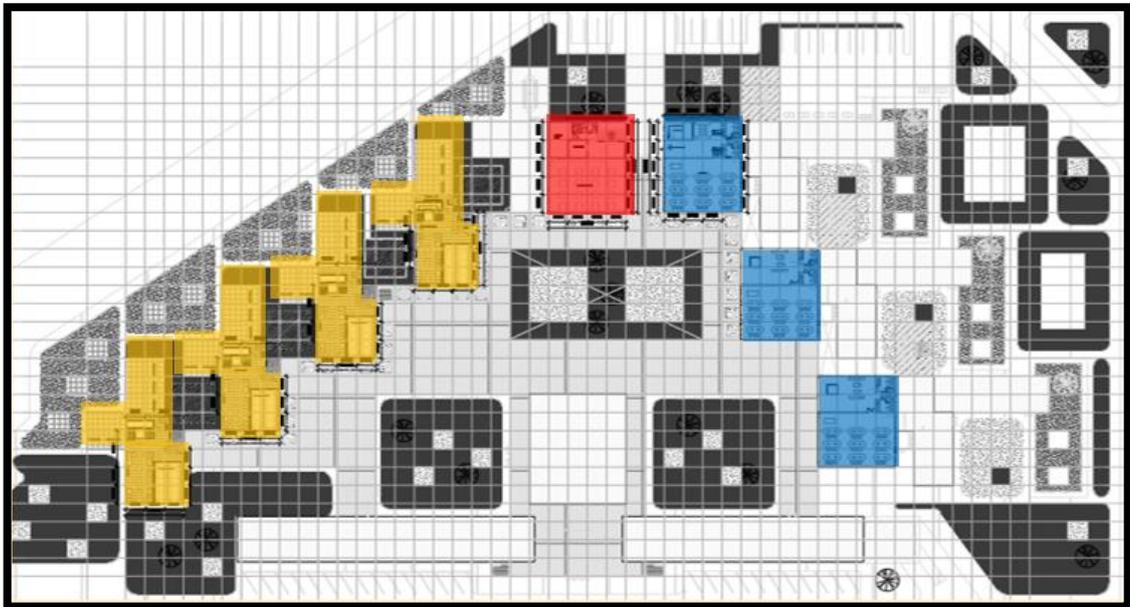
Imagen del Plano de Zonificación del Primer Piso
